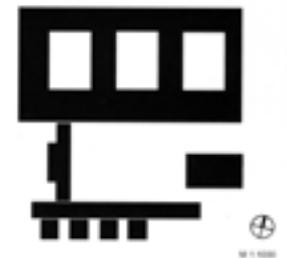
Lageplan und schematischer Grundriss des Philosophicum. Zeichnung: Hauke Horn.
